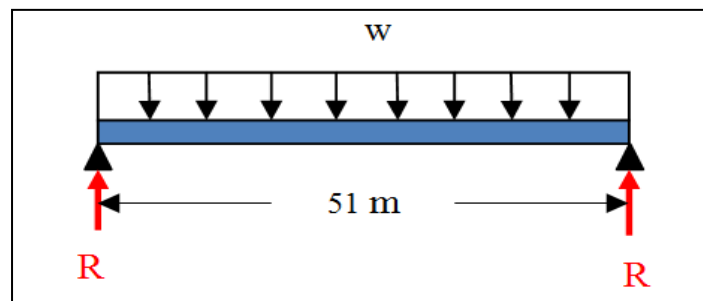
Esquema de cálculo del puente Barranca Honda, un claro
